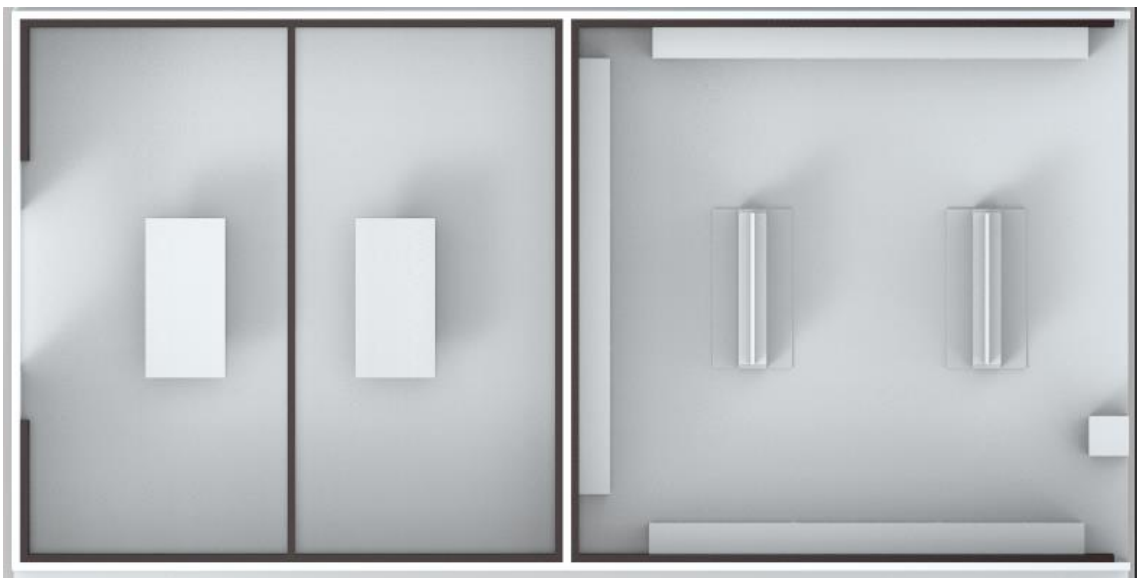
Vista en planta de la estructura interna (fuente propia)
